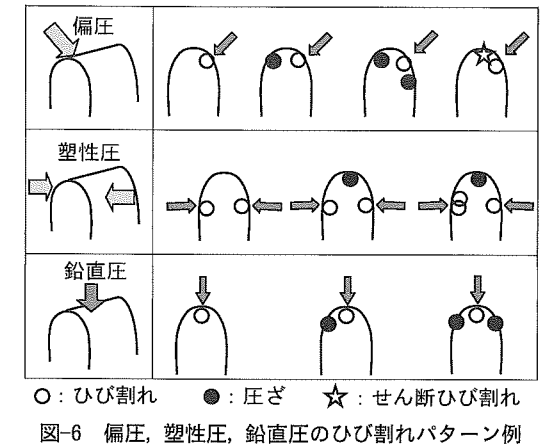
偏圧、塑性圧、鉛直圧のひび割れパターン例
